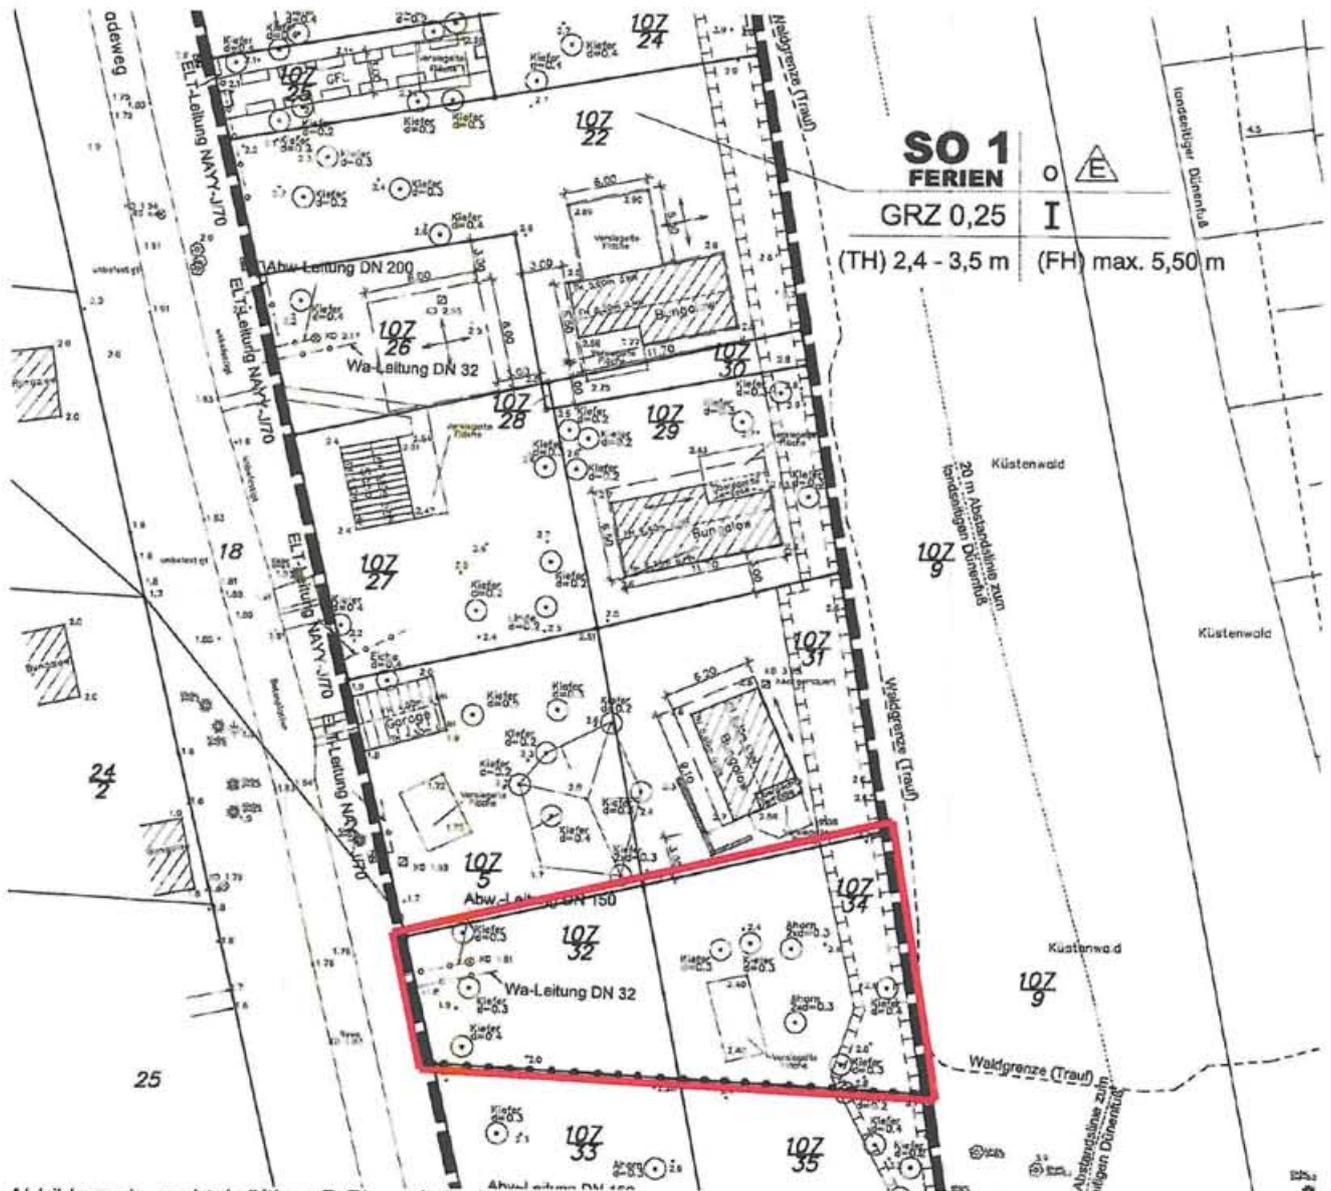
rechtskräftiger B-Plan mit Änderungsbereich
